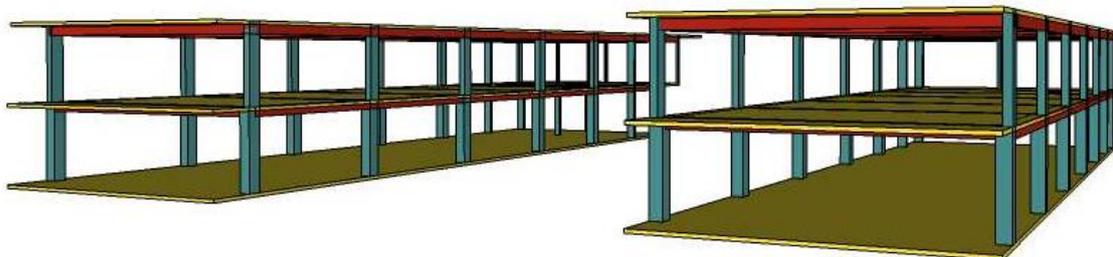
Elementos Estruturais pavimento do subsolo e inferior
